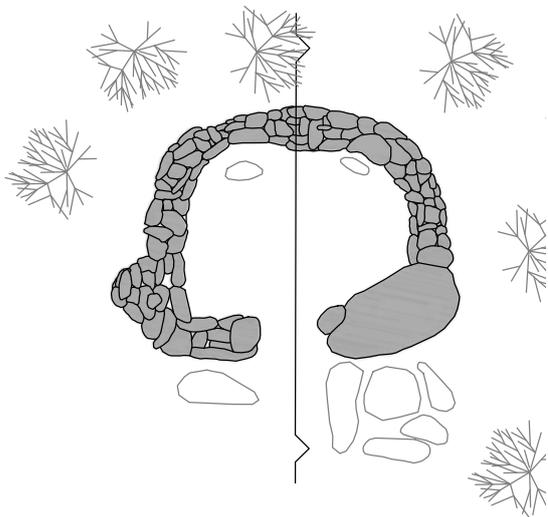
Planta del casal "A" de Ruta el Sardón en Bermillo de Sayago. Fuente: Elaboración propia.
